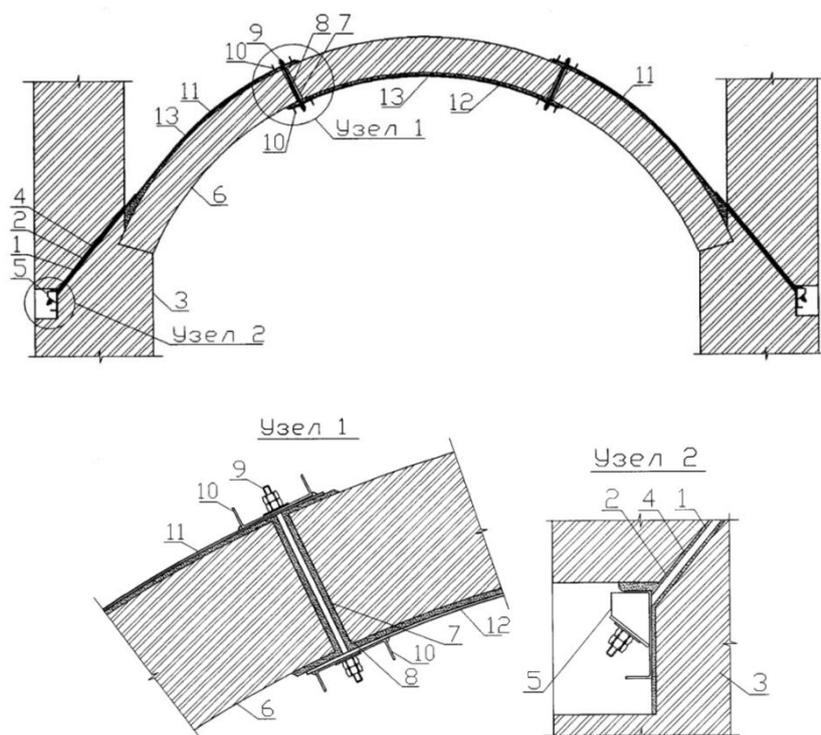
Усиление арки композитными материалами на основе углеволокна: 1 – арматура; 2 – отверстия; 3 – несущая стена; 4 – инъецированный раствор; 5 – анкера; 6 – усиливаемая арка; 7 – отверстия; 8 – инъецированный раствор; 9 – резьбовые шпильки; 10 – швеллер; 11, 12 – стальные полосы; 13 – расширяющийся раствор
